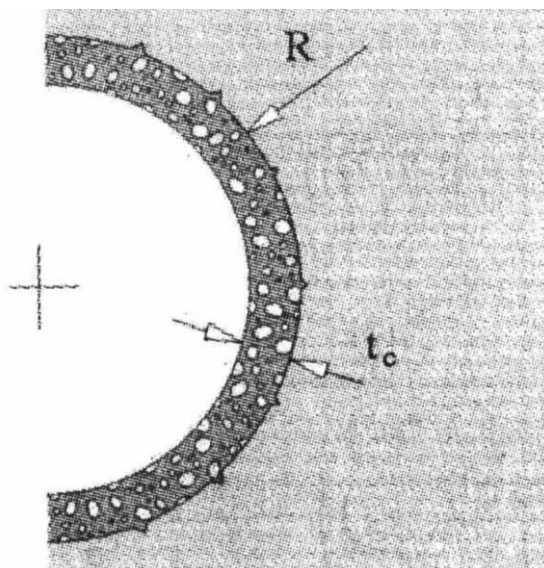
Representación de una sección de hormigón u Hormigón proyectado (Brady y Brown, 1983)
